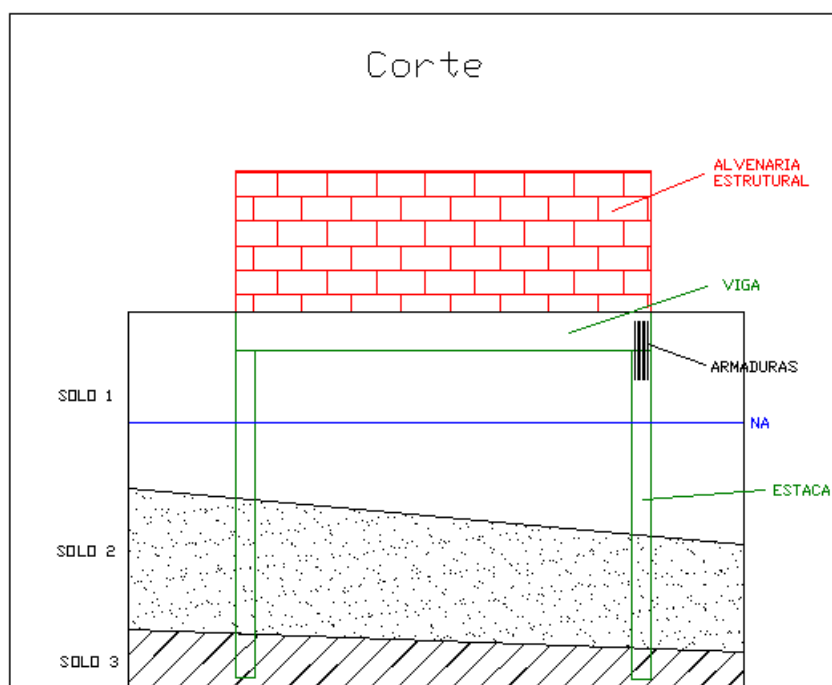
representação esquemática em corte da ligação vigas-baldrame/estacas
